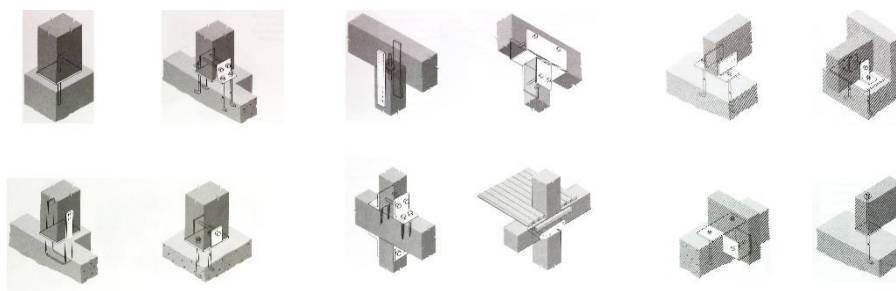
Tipos de ligações entre pilares, vigas, lajes e paredes (Canadian Wood Council, 1997).
